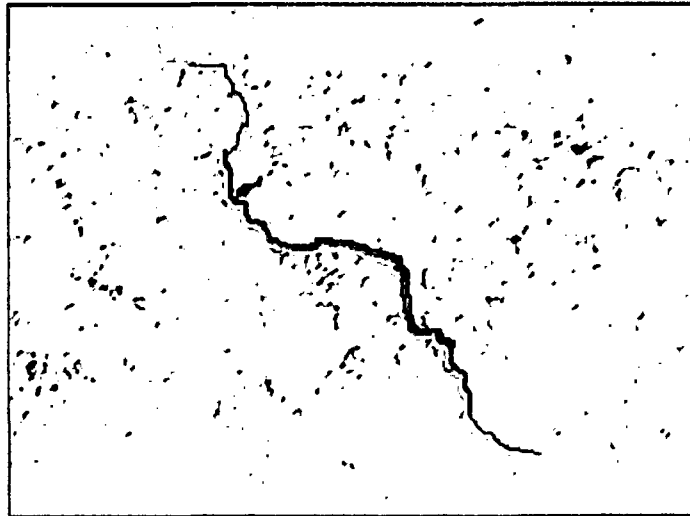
Grieta primaria y secundaria por flexión en el concreto
